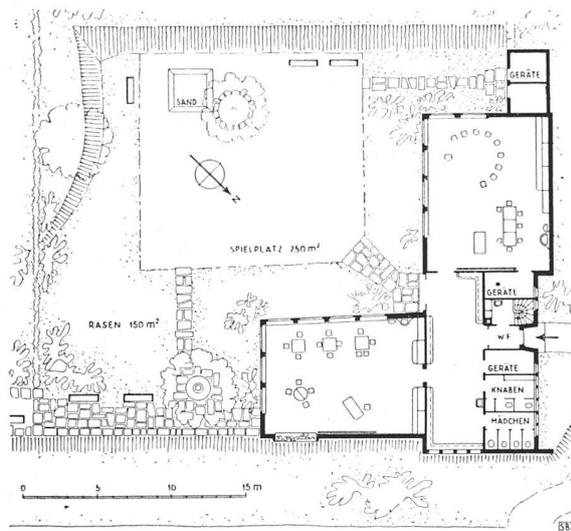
Grundriß 1:300 | Plan | Ground floor
